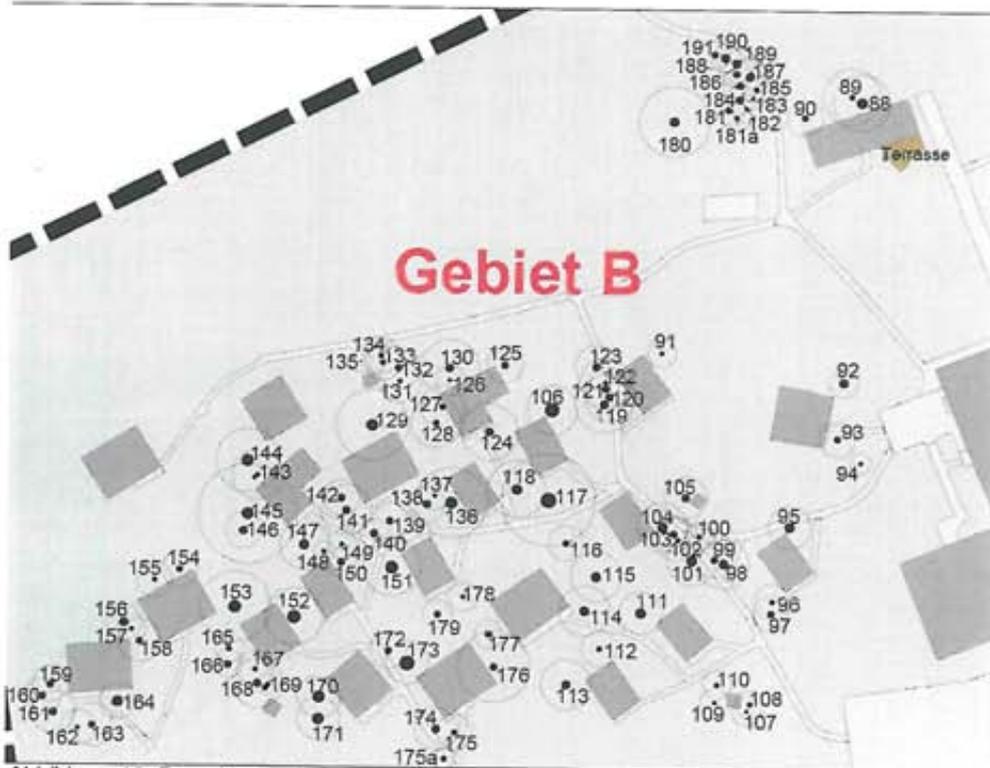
Baumbestand, Ausschnitt B, Darstellung unmaßstäblich
